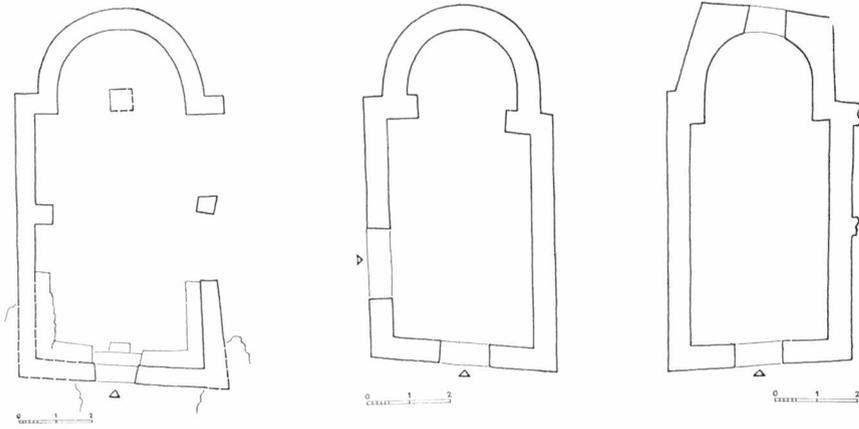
Pianta della chiesa sull'isoletta Lučnjak (secondo I. Fisković).
